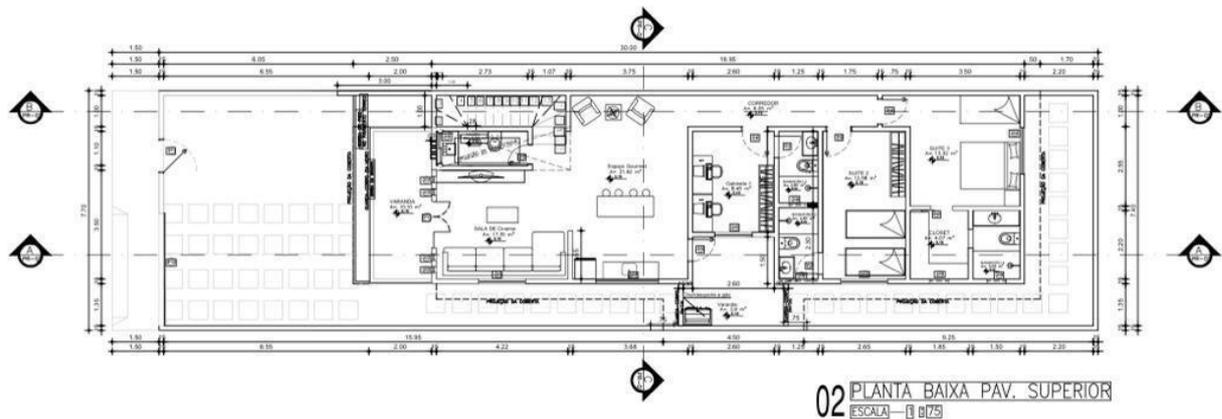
Planta Baixa Obra 03- Pavimento 1
